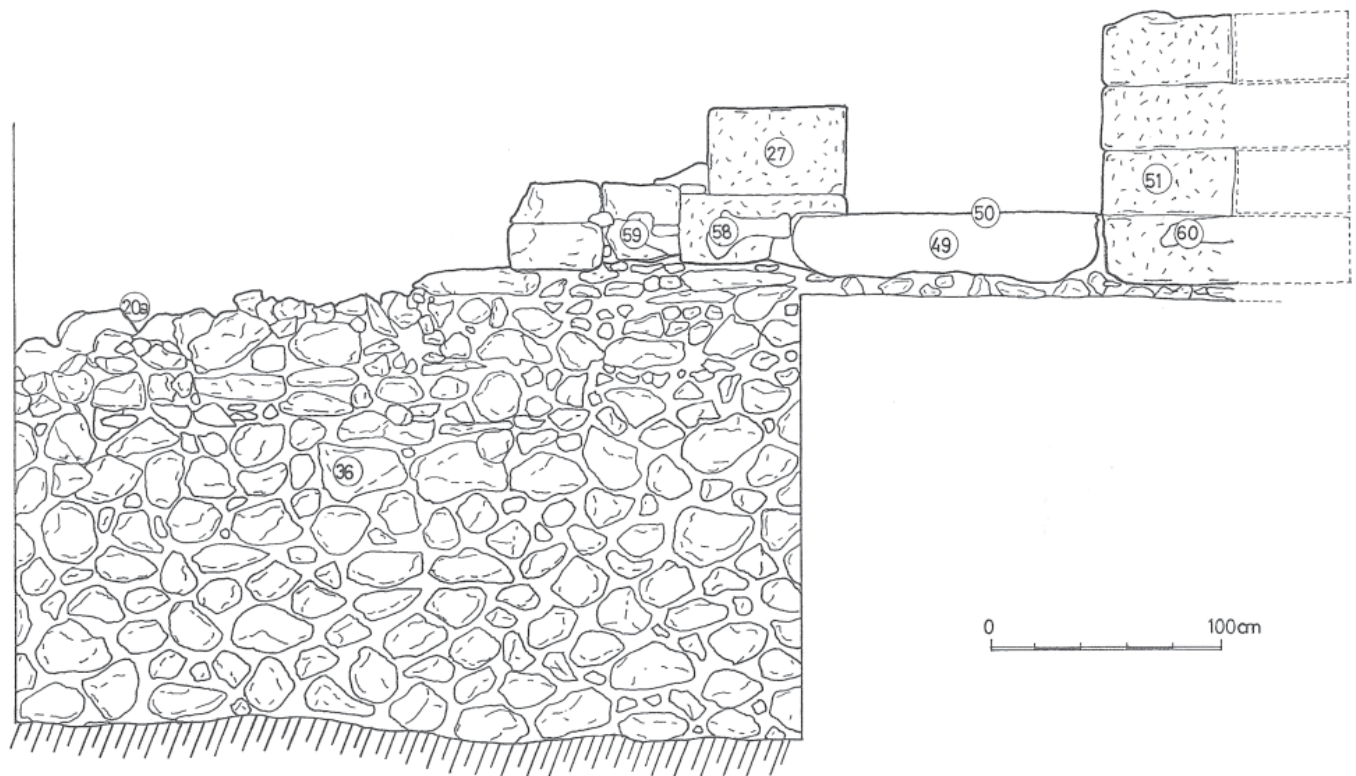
Alzado de la cara norte del muro y cimentación romanos.
